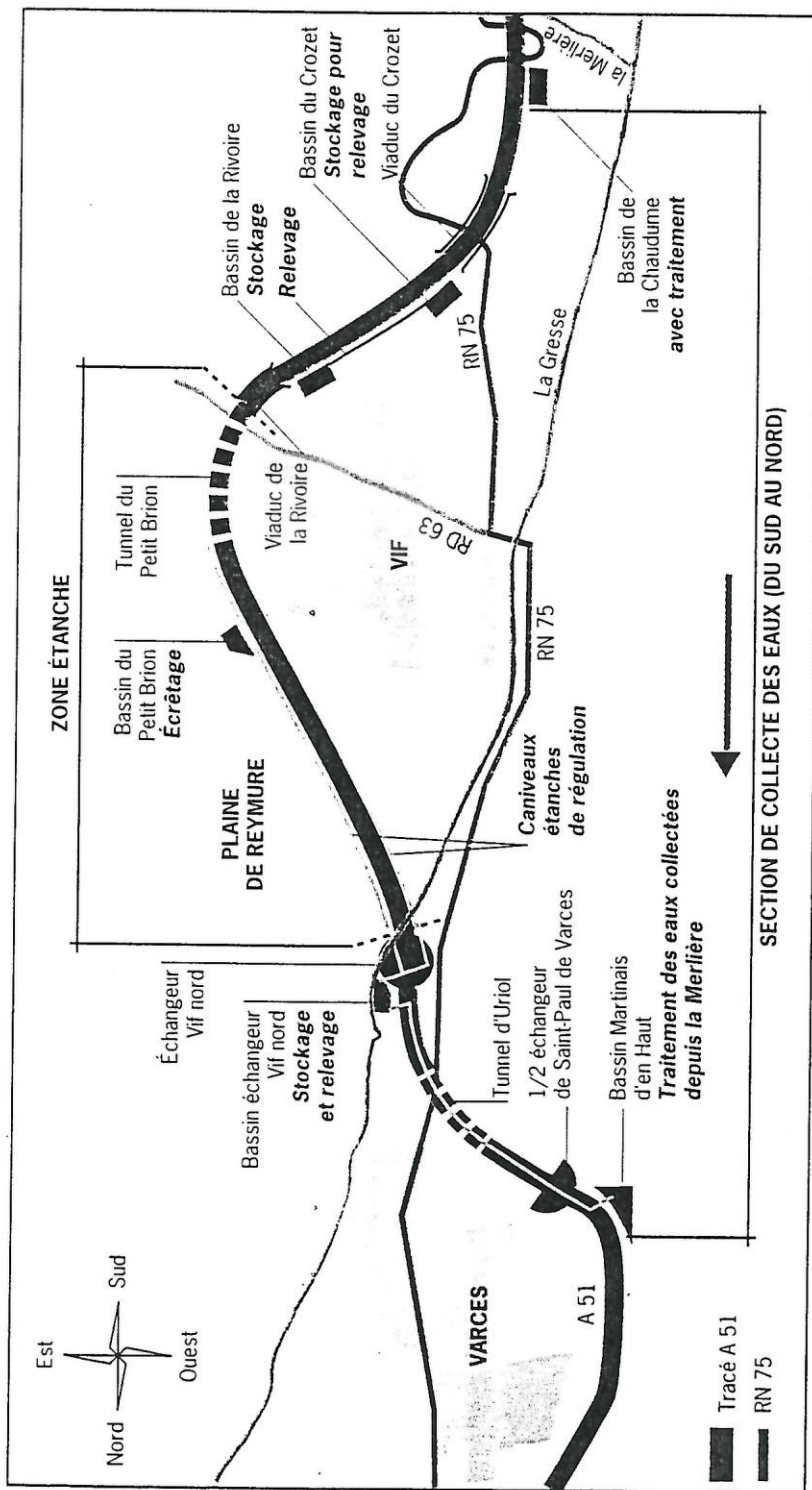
Assainissement de la plate-forme autoroutière sur la section Grenoble-Coynele
